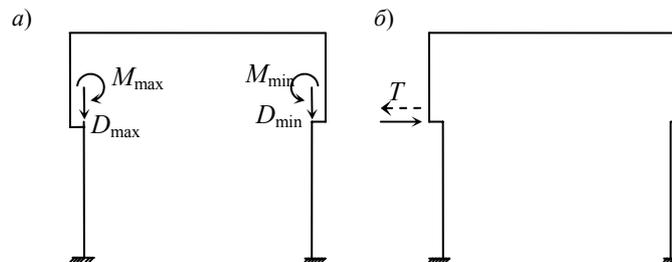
Расчётная схема рамы от вертикальной (а) и горизонтальной (б) крановой нагрузки
